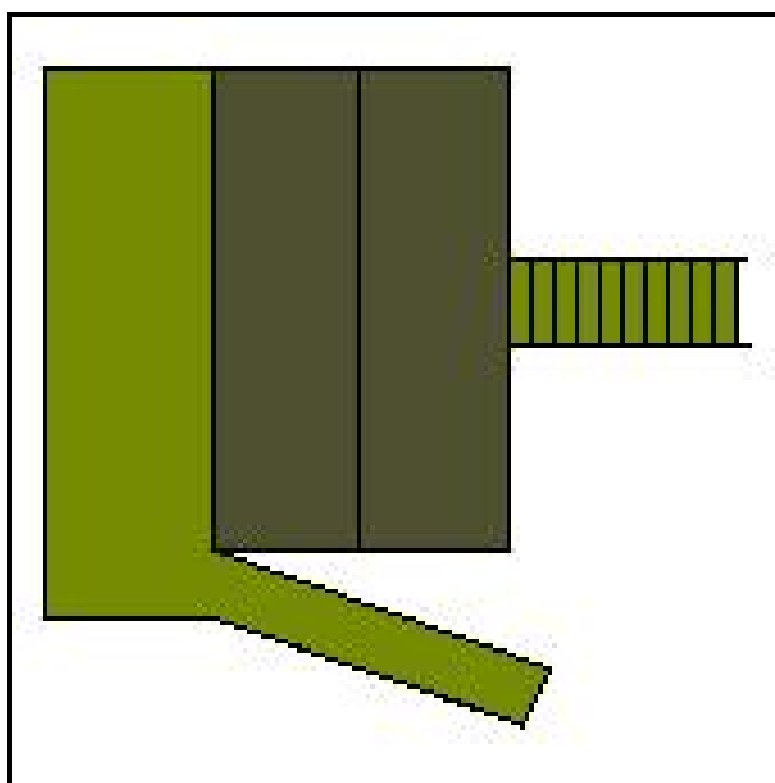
Croquis de la plataforma accesible y la rampa que conecta el sendero C, construidas en la cara posterior del observatorio actual a una altura de un metro.
